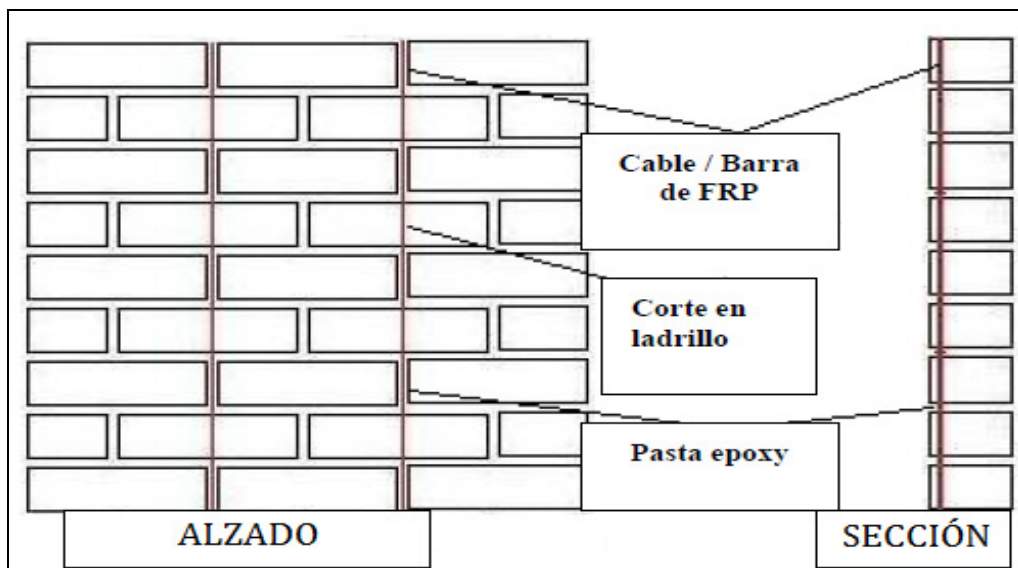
Ejemplo de refuerzo vertical en un muro para resistir carga por flexión.
